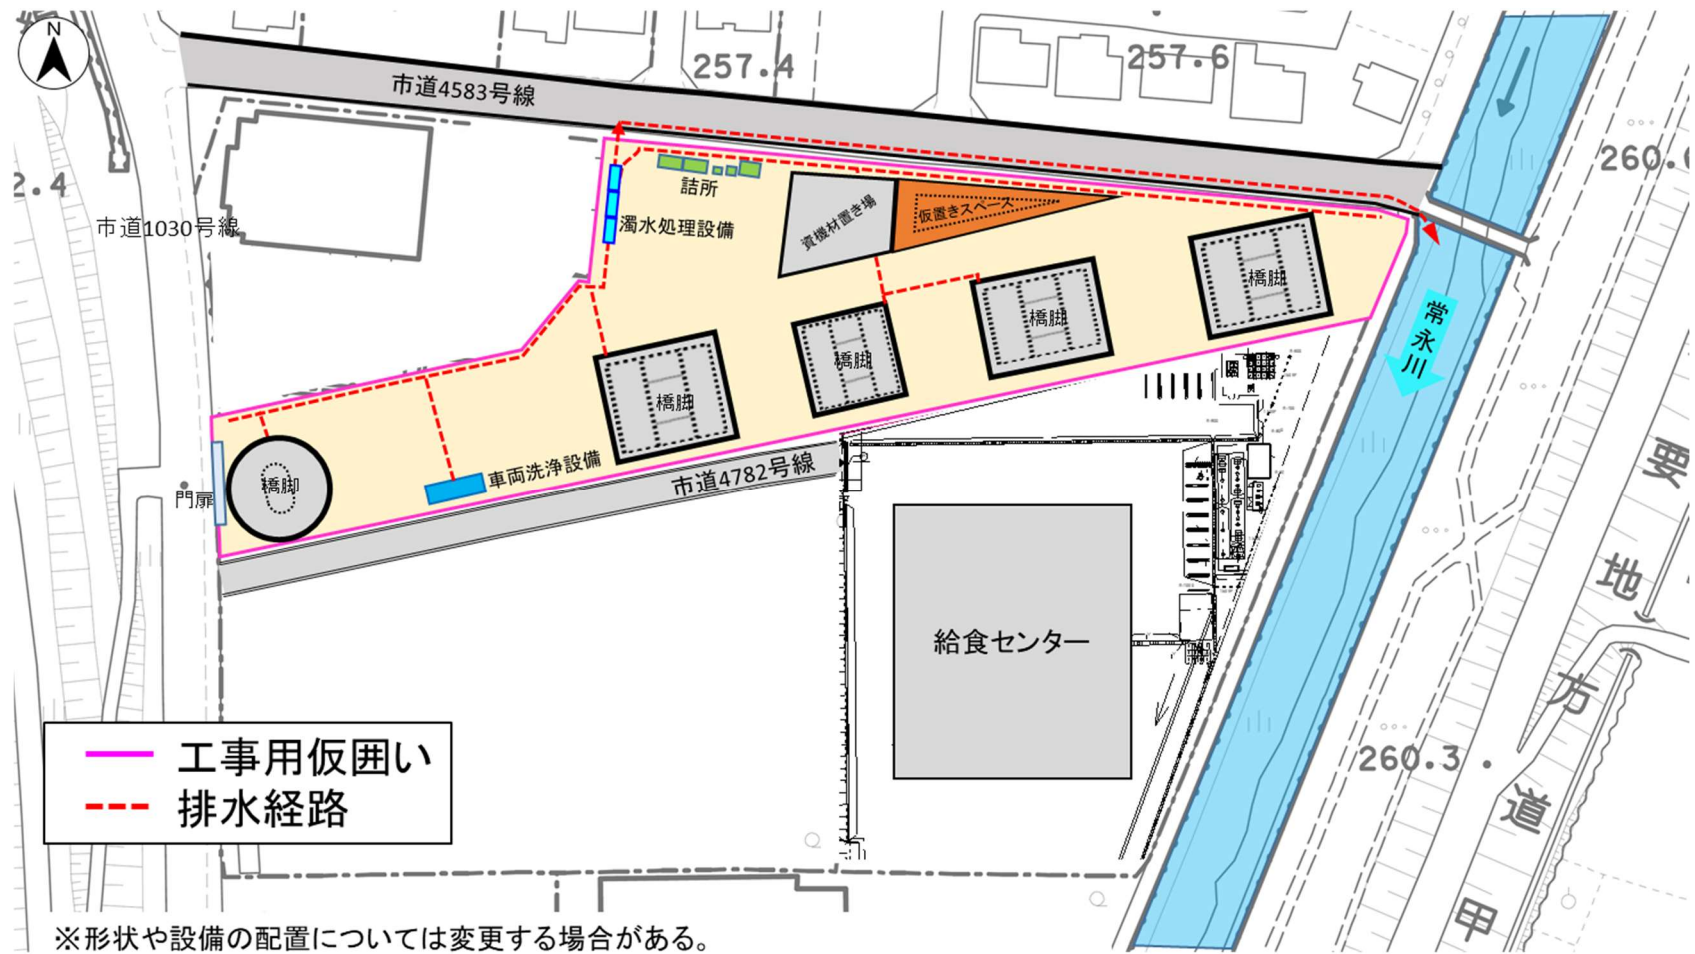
(1) 工事施工ヤード設備配置図 (釜無川右岸)
